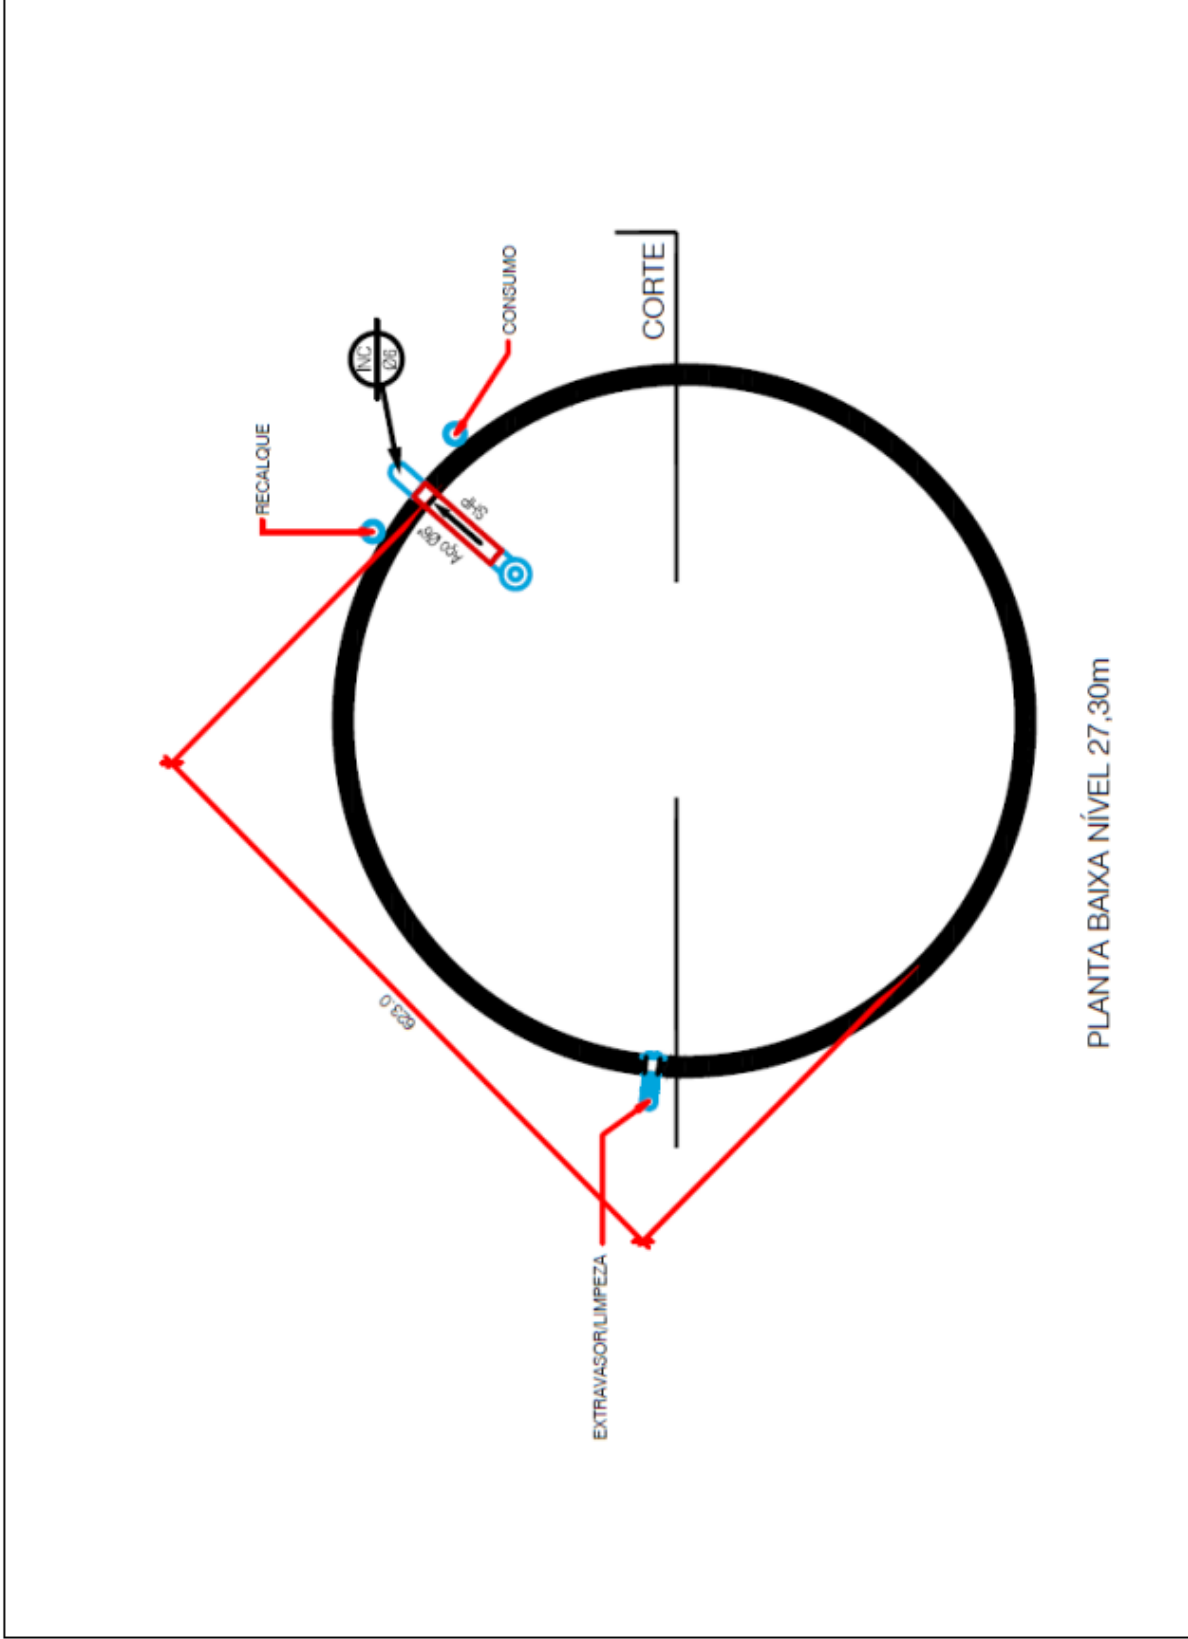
Planta Baixa nível, evidenciando tubulações existentes;
